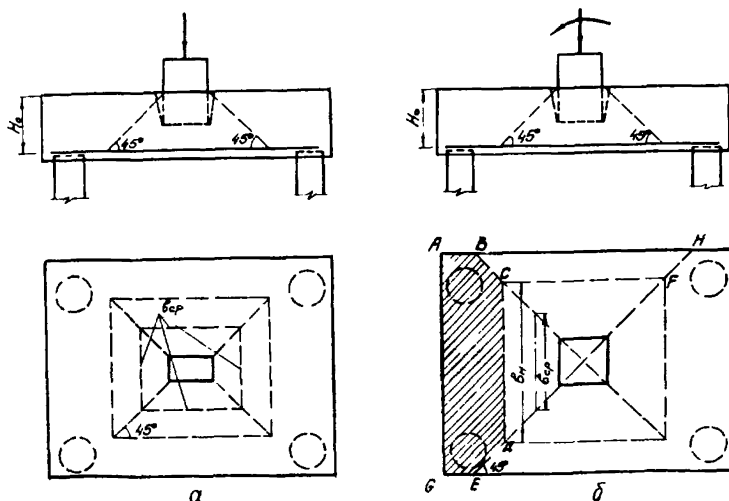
Схемы пирамиды продавливания в железобетонных ростверках при нагружении:
